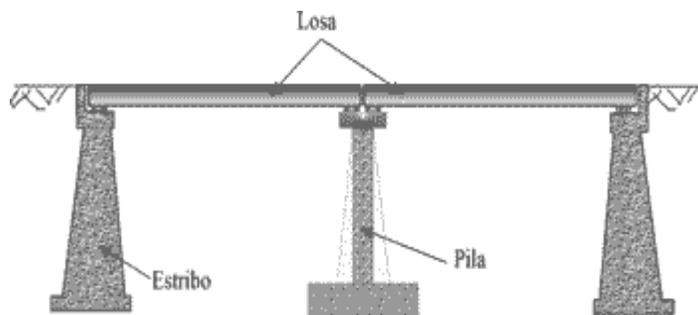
Puente de losa maciza de Concreto Armado. Tomado de página web: ingenierocivilinfo.com.
